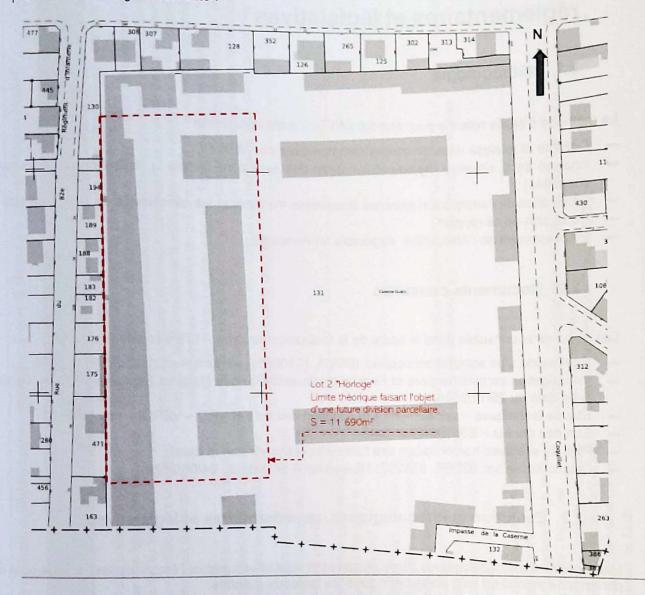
Localisation du site sur fond de plan cadastral (Source: NEXITY)
